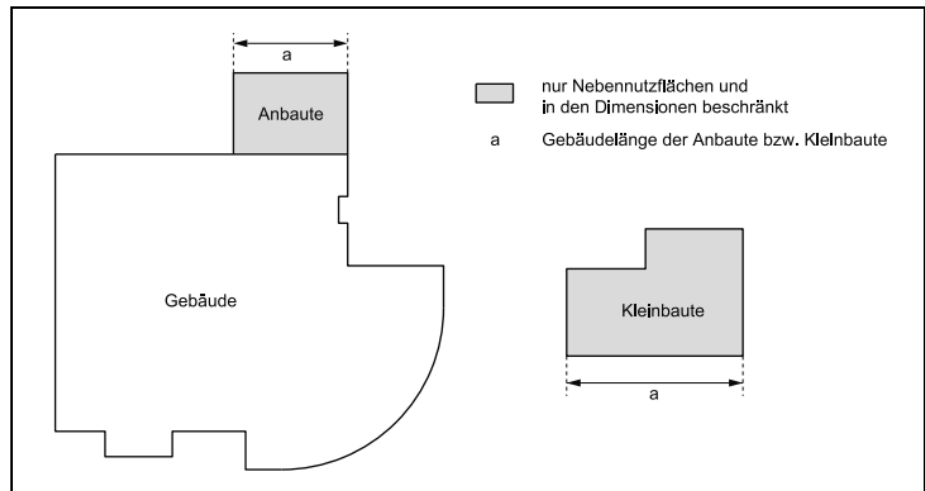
Schema Gebäude, Kleinbauten und Anbauten gemäss §§2, 2a ABV)
